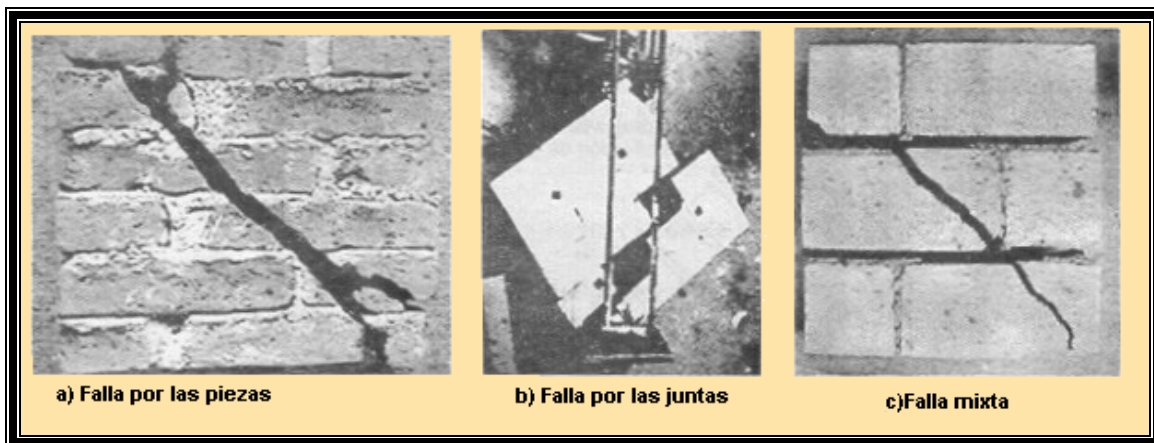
Tipos de fallas de la mampostería en un ensaye a tensión diagonal
